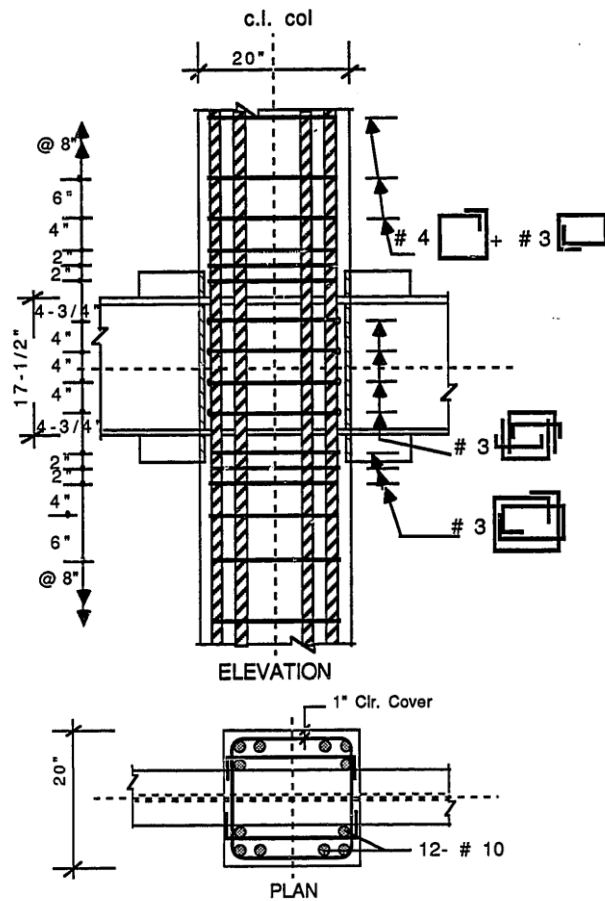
Detalle del refuerzo en la junta para la prueba 8, en vista de corte y vista de planta. *Nota.* Shikh muhammad t. moment connections between steel beams and concrete columns (1987) (pág.53)
